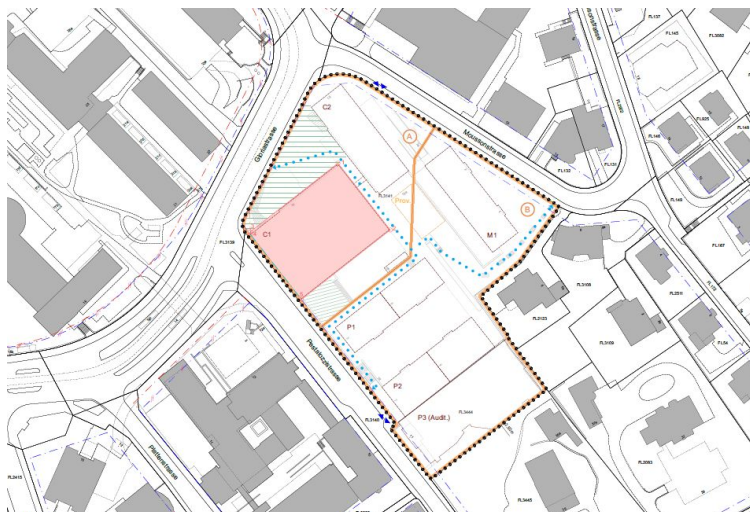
Gestaltungsplan mit Geltungsbereich (schwarz punktiert), Teilgebiete A und B (gelb-orange) sowie Bau-
